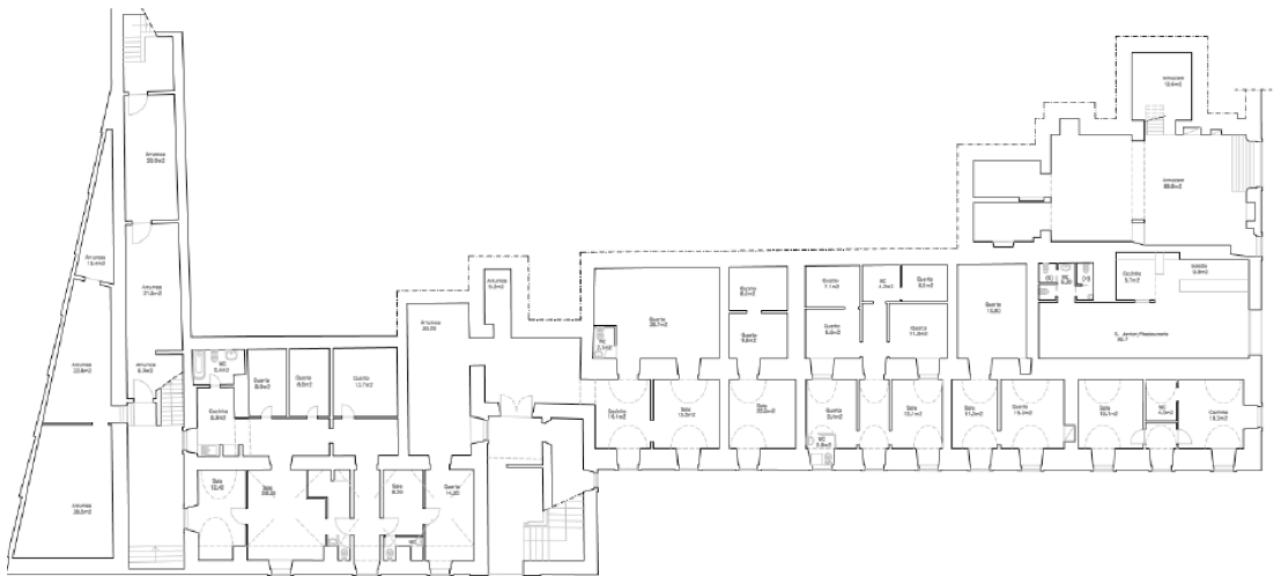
Planta original da cave da Casa do Governador, sem escala
